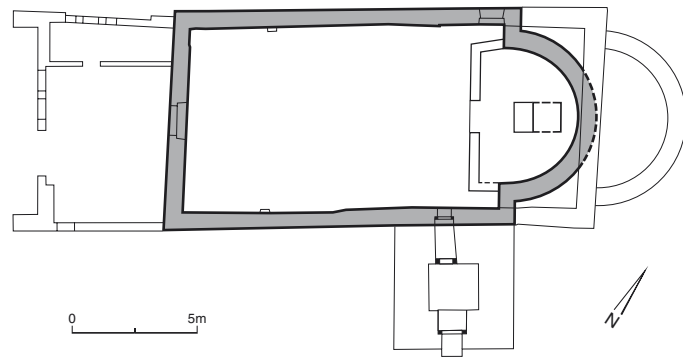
Leissigen. Kirche des 11. Jahrhunderts. Rekonstruierter Grundriss. M 1:300.
